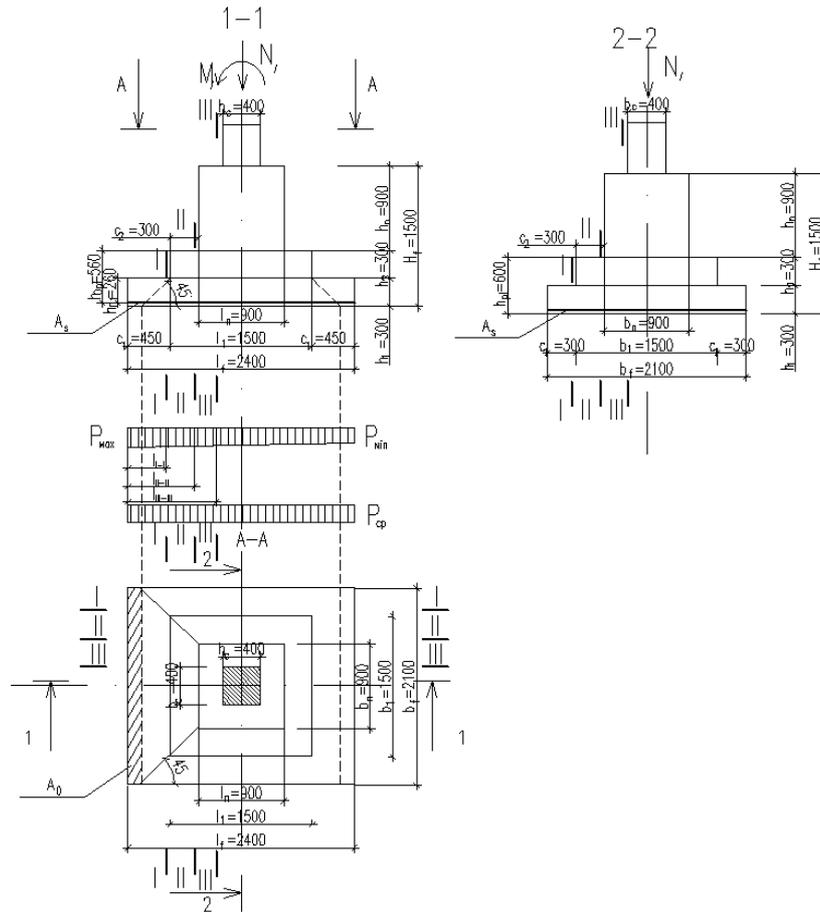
К определению высоты фундамента, конструирование фундамента и к расчету прочности плитной части на продавливание.
